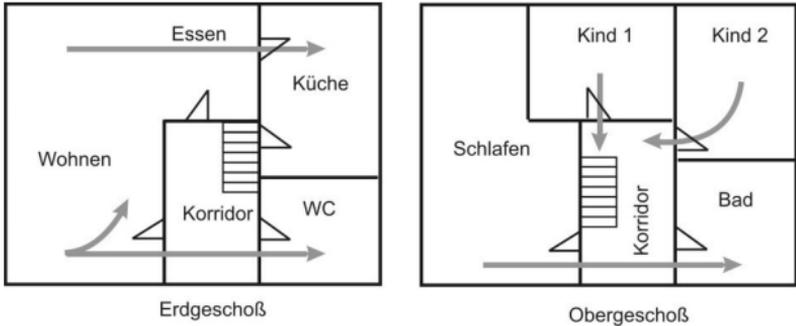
Grundriss Querlüftung (Quelle: PAUL)
